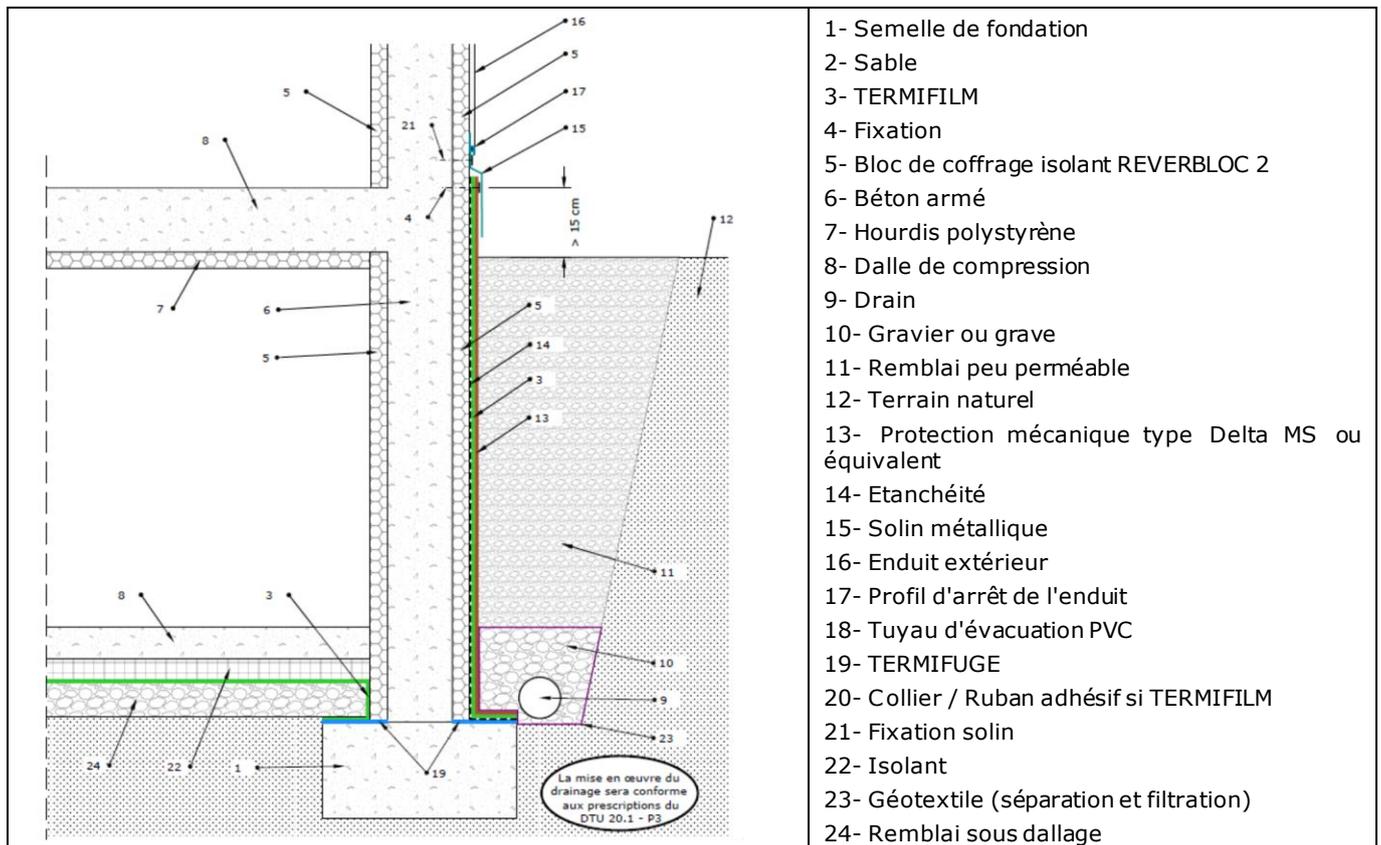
Mur extérieur de sous-sol enterré avec dallage désolidarisé isolé
